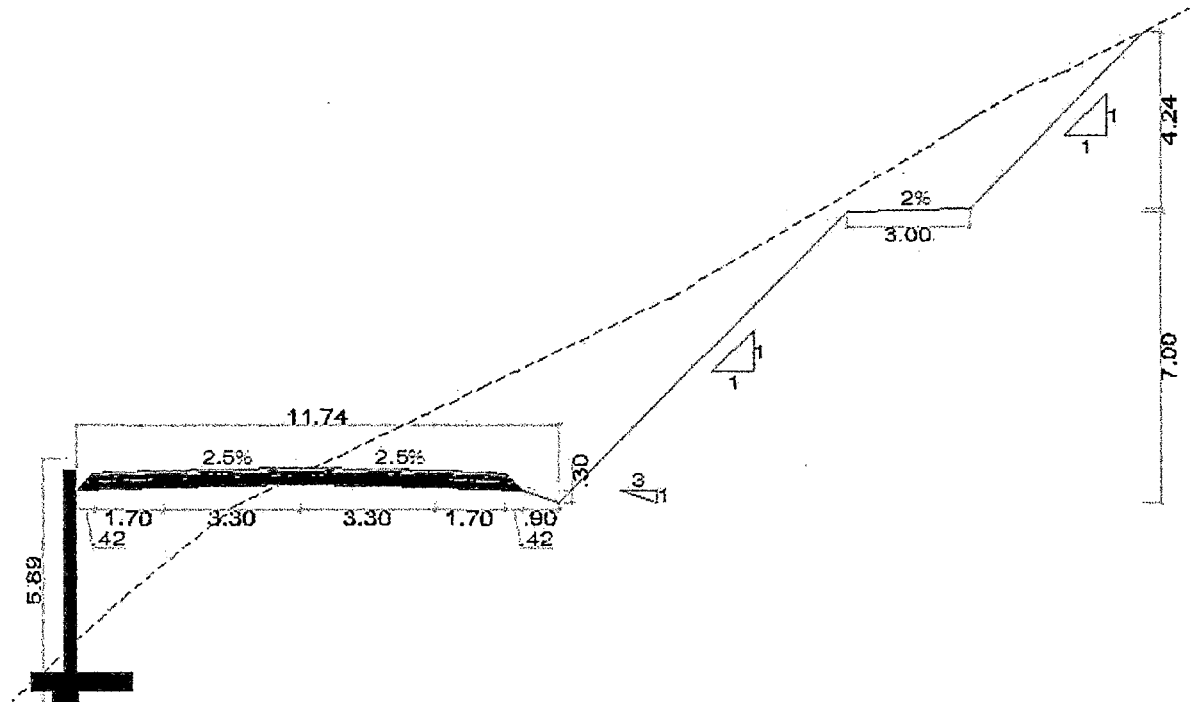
Sección transversal (en corte) en tangente con muro de contención y banquetas - Fuente. Elaboración Propia
